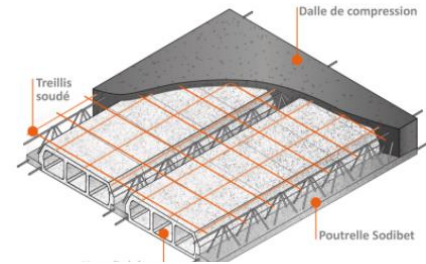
plancher en corps creux / source : <http://www.sodibet.com/planchers.php>
